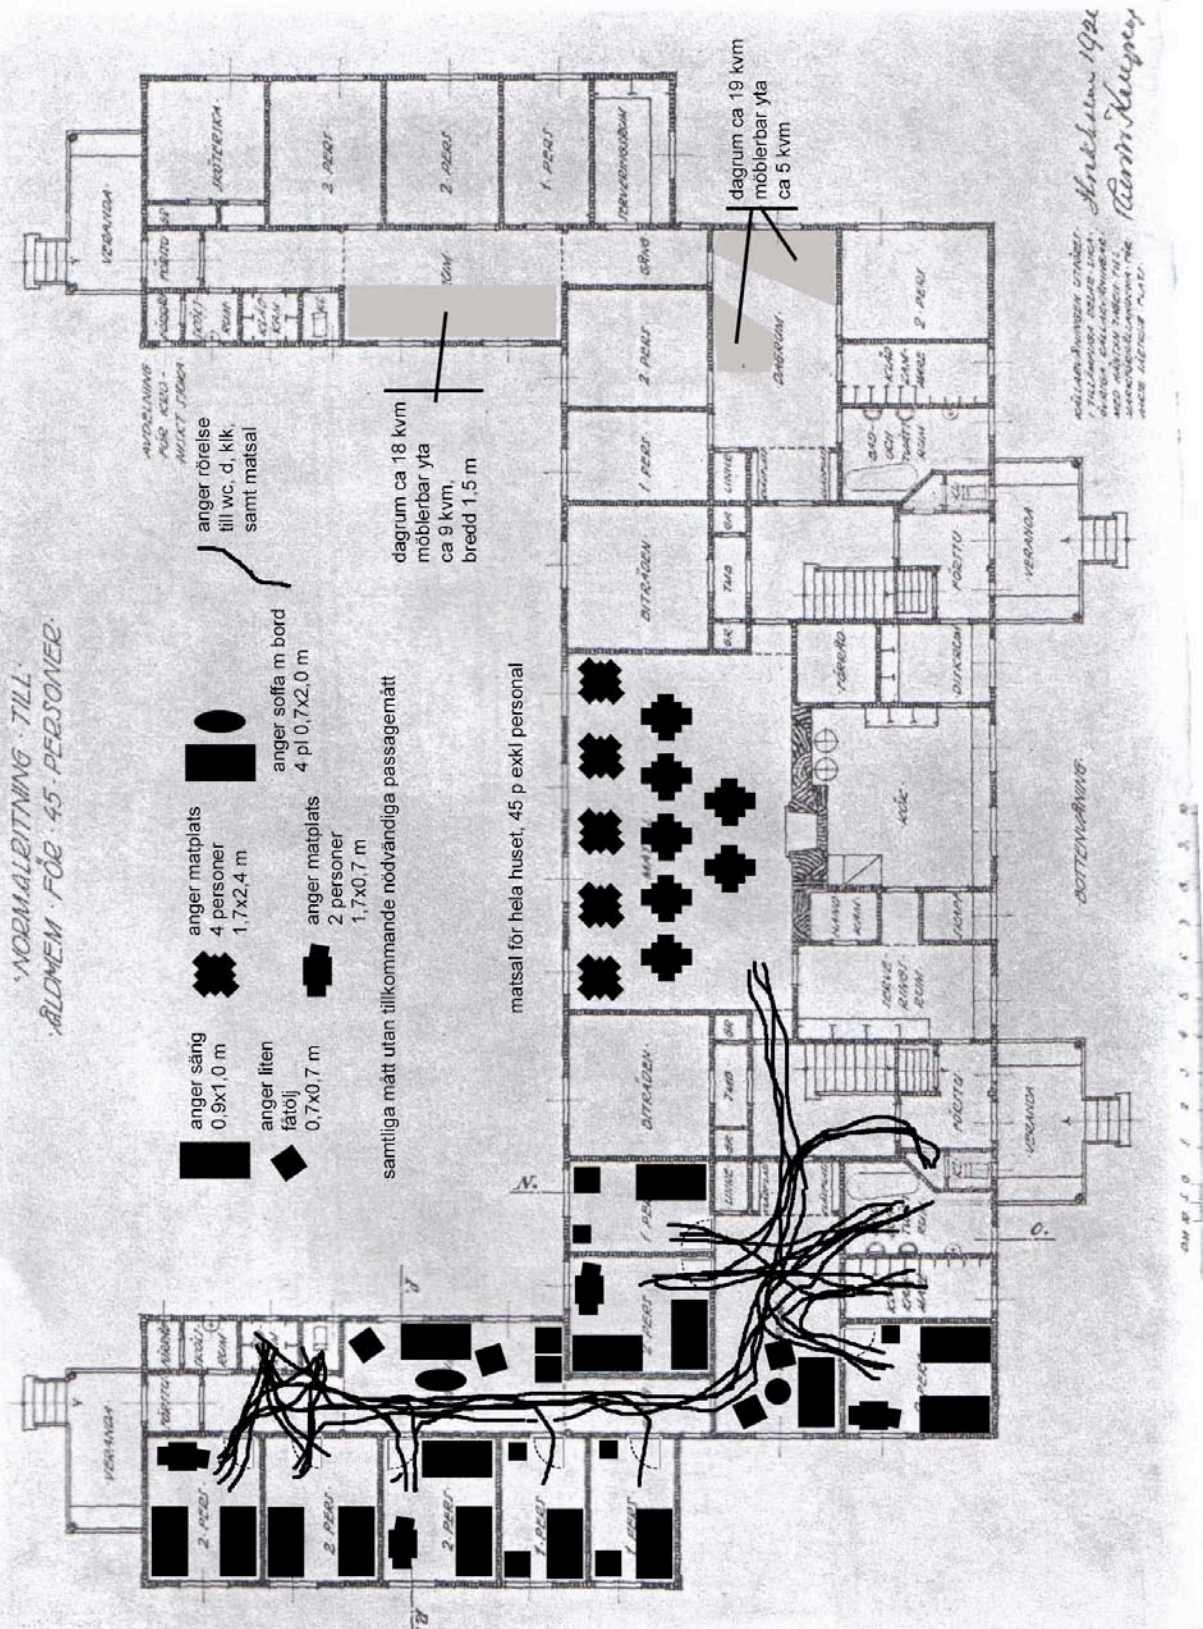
Planlösning ålderdomshem för 45 personer (Civildepartementet 1920, plansch 24)
